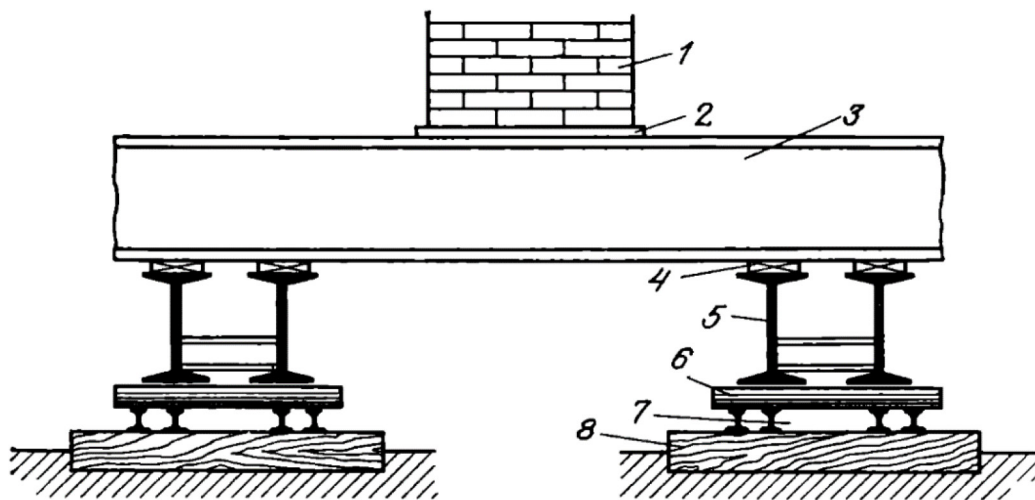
Расположение путей с обеих сторон стены: 1 – стена; 2 – деревянные площадки; 3 – поперечная балка; 4 – клинья; 5 – ходовые балки; 6 – катки; 7 – рельсы; 8 – шпалы [1]
